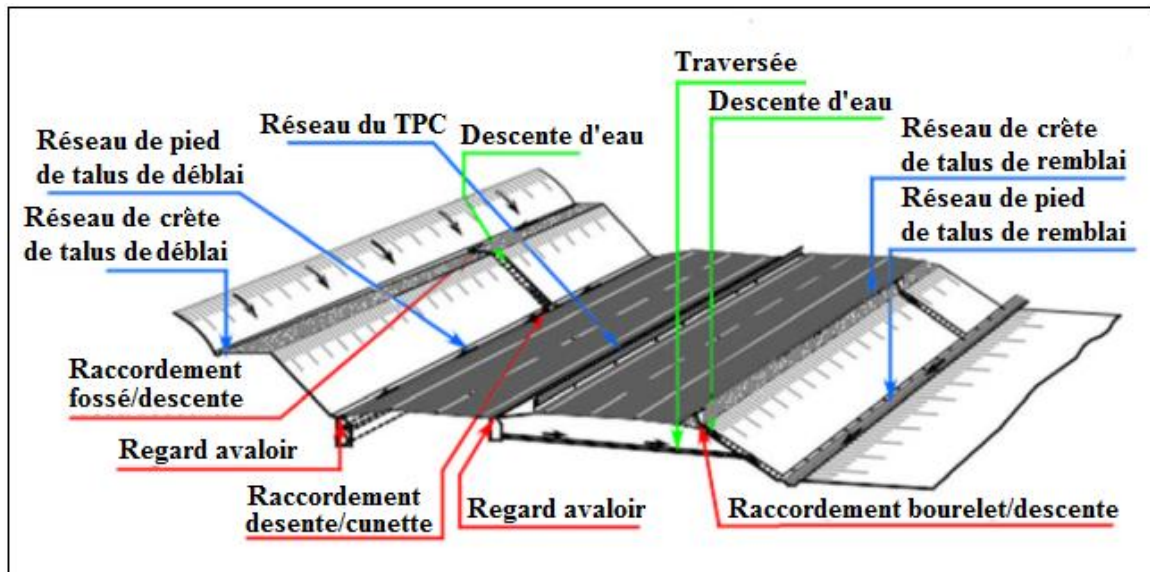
Elément d'assainissement de la plate forme d'une chaussée routière.
